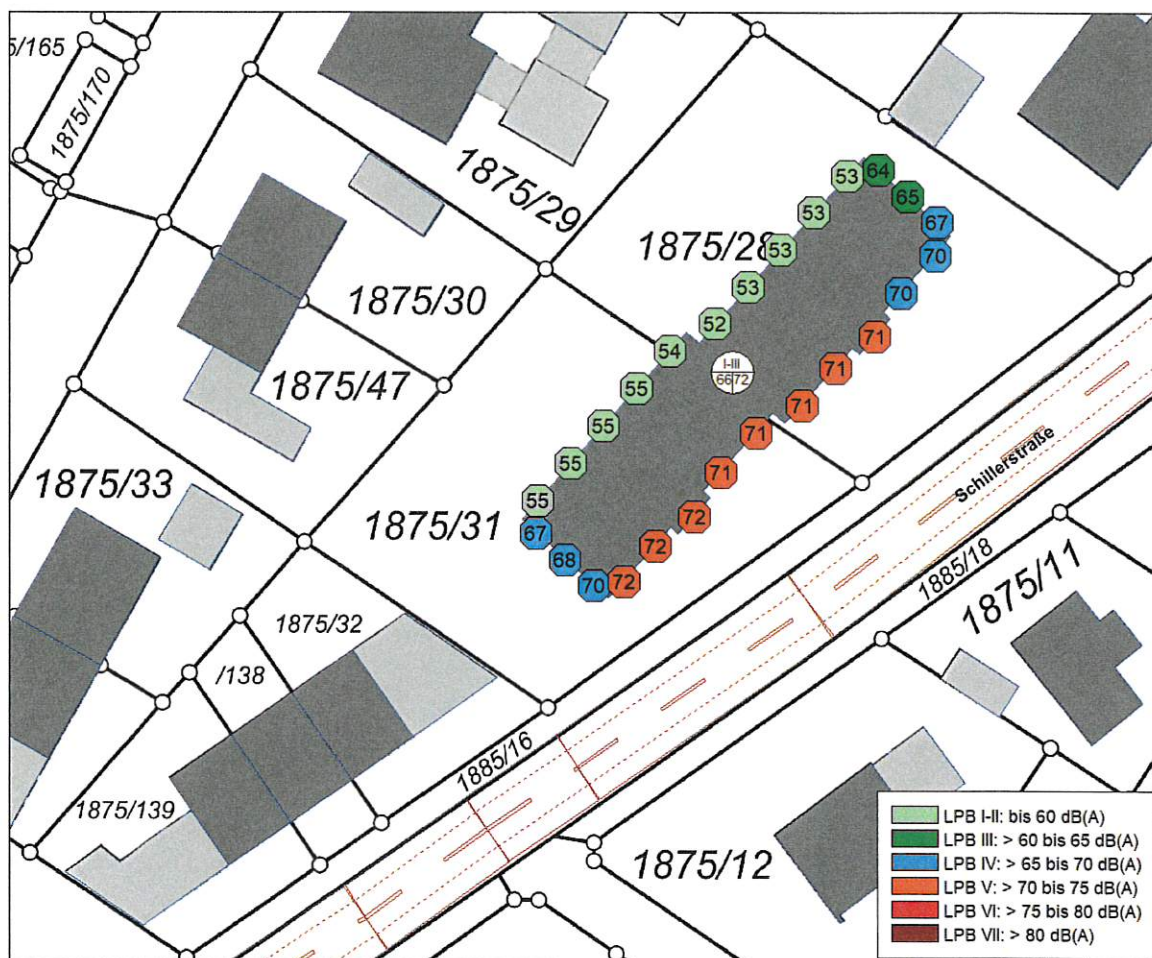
Baulicher Schallschutz für das Vorhaben, Darstellung lautestes Stockwerk
